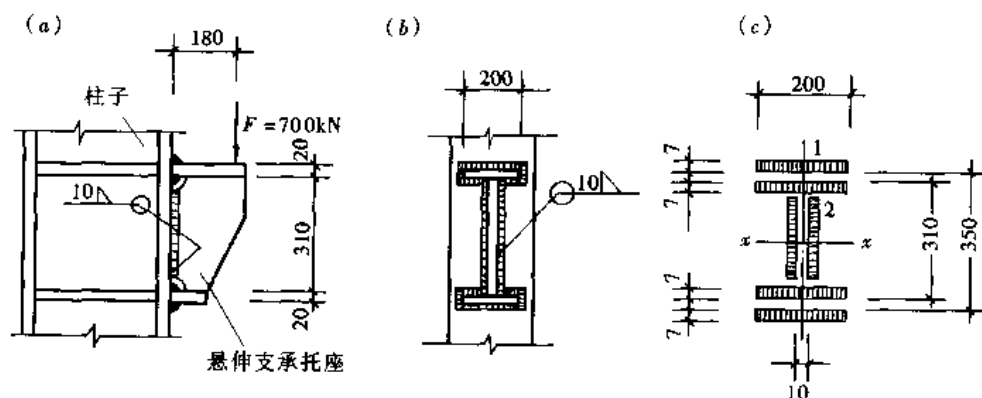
悬伸支承托座（牛腿）与钢柱的焊接连接图示
